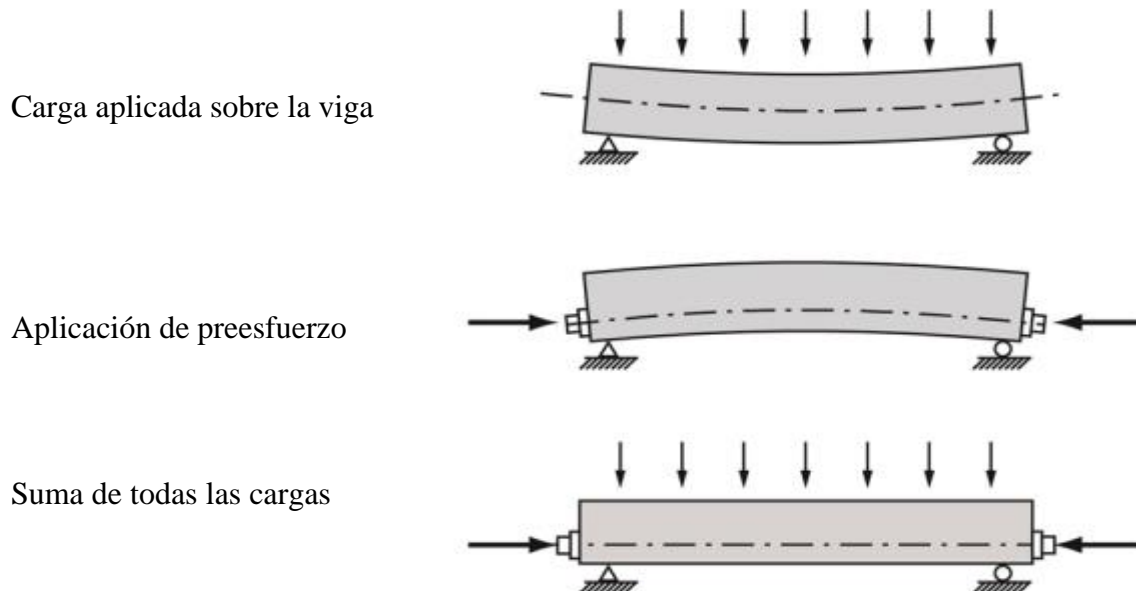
Concepto de concreto preesforzado (Adaptado de FHWA, 2016).
